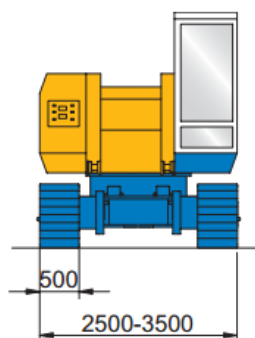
Vrtná souprava velko-průměrových pilot Bauer BG 12 H [24]
